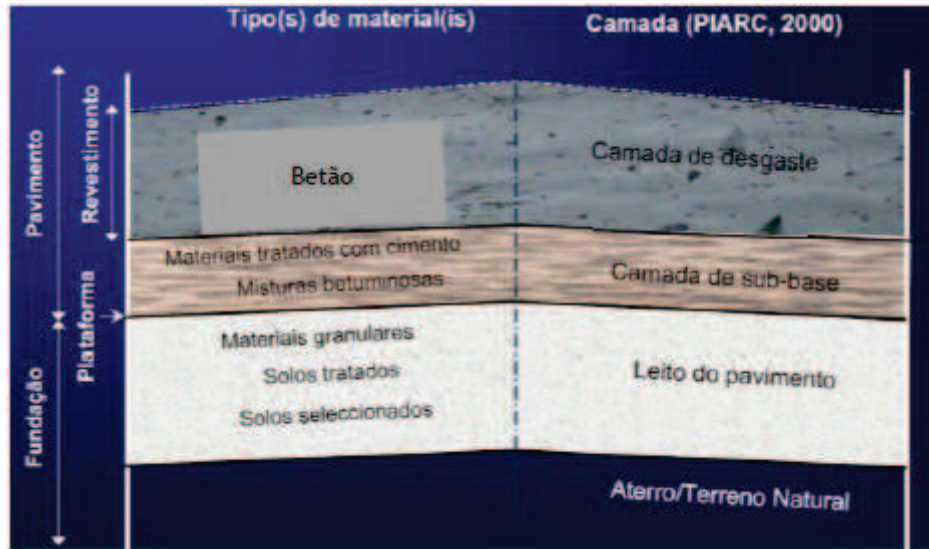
Constituição de um pavimento rígidos (LNEC, 2005)
